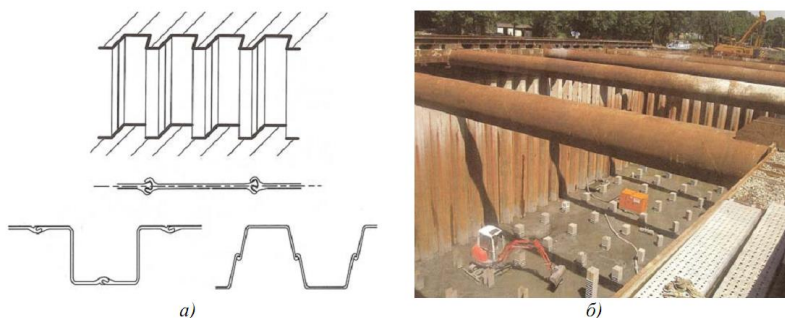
Шпунтовое ограждение котлована: а – типы профиля; б – общий вид котлована со шпунтовым ограждением и креплением расстрелами
